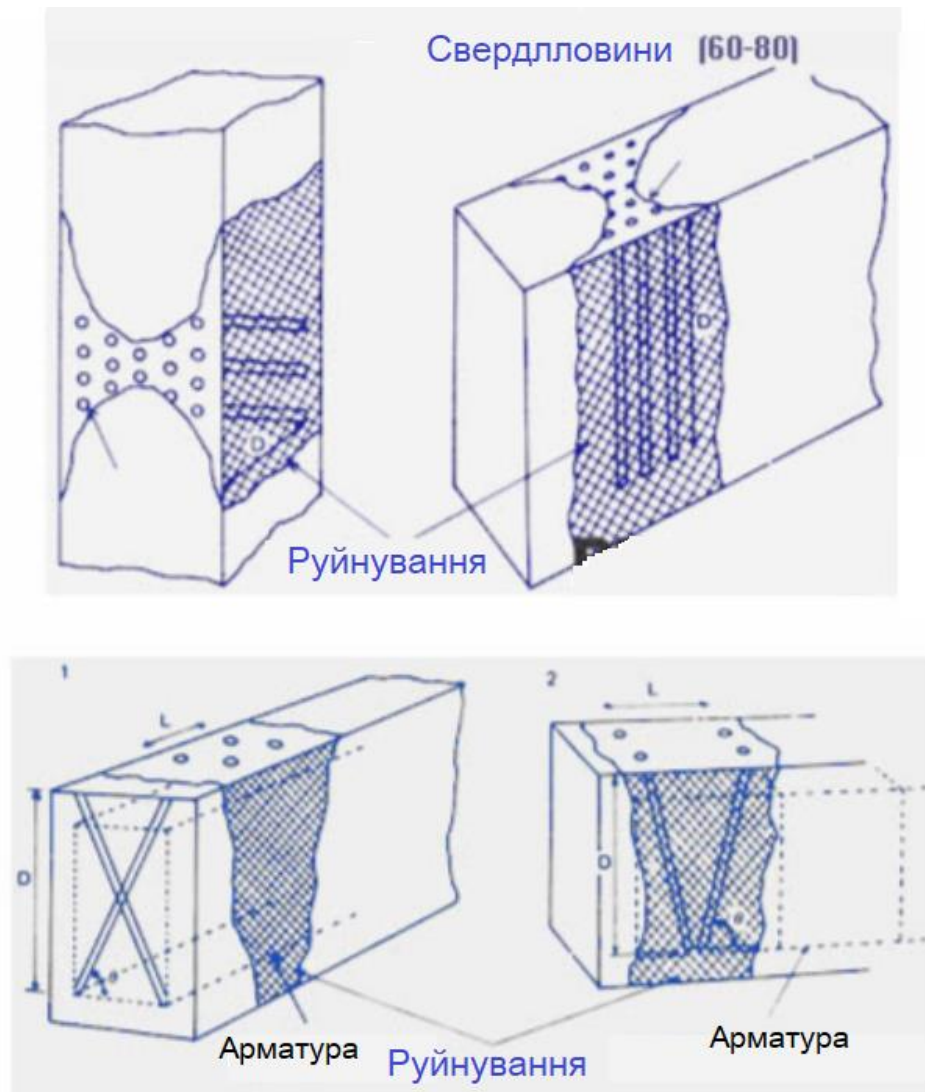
Схема руйнування конструкцій «тихий вибух»
